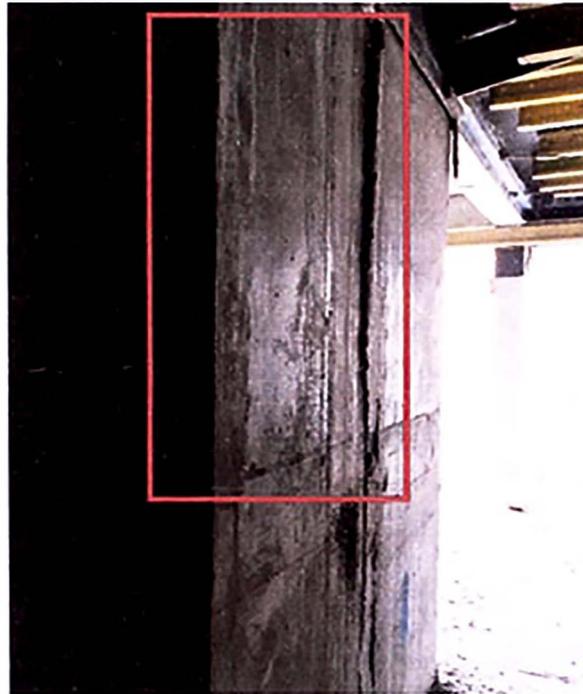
Desplome en encuentro de columna y viga con falta de recubrimiento.
